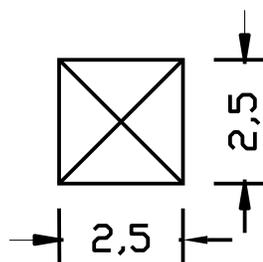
通訊鐵塔頂部平面示意圖 單位 (m)
